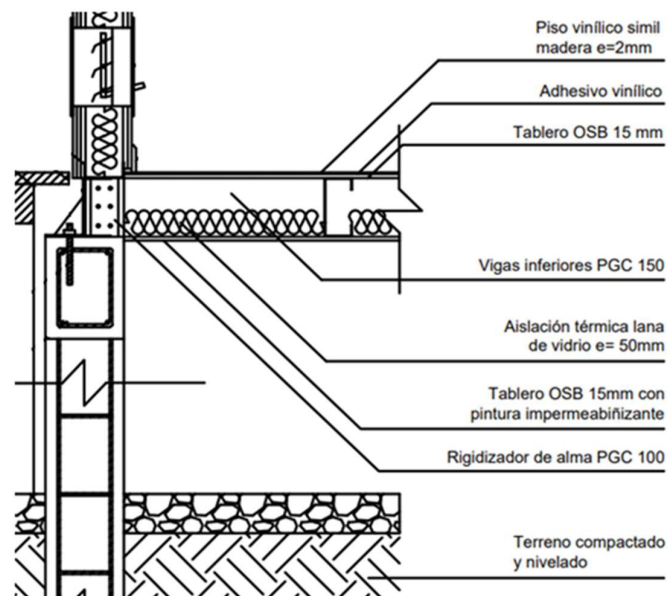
| Detalle modelo del paquete estructural del entrepiso. Fuente: <https://es.scribd.com/document/613553921/detalle-1-20-steel>
